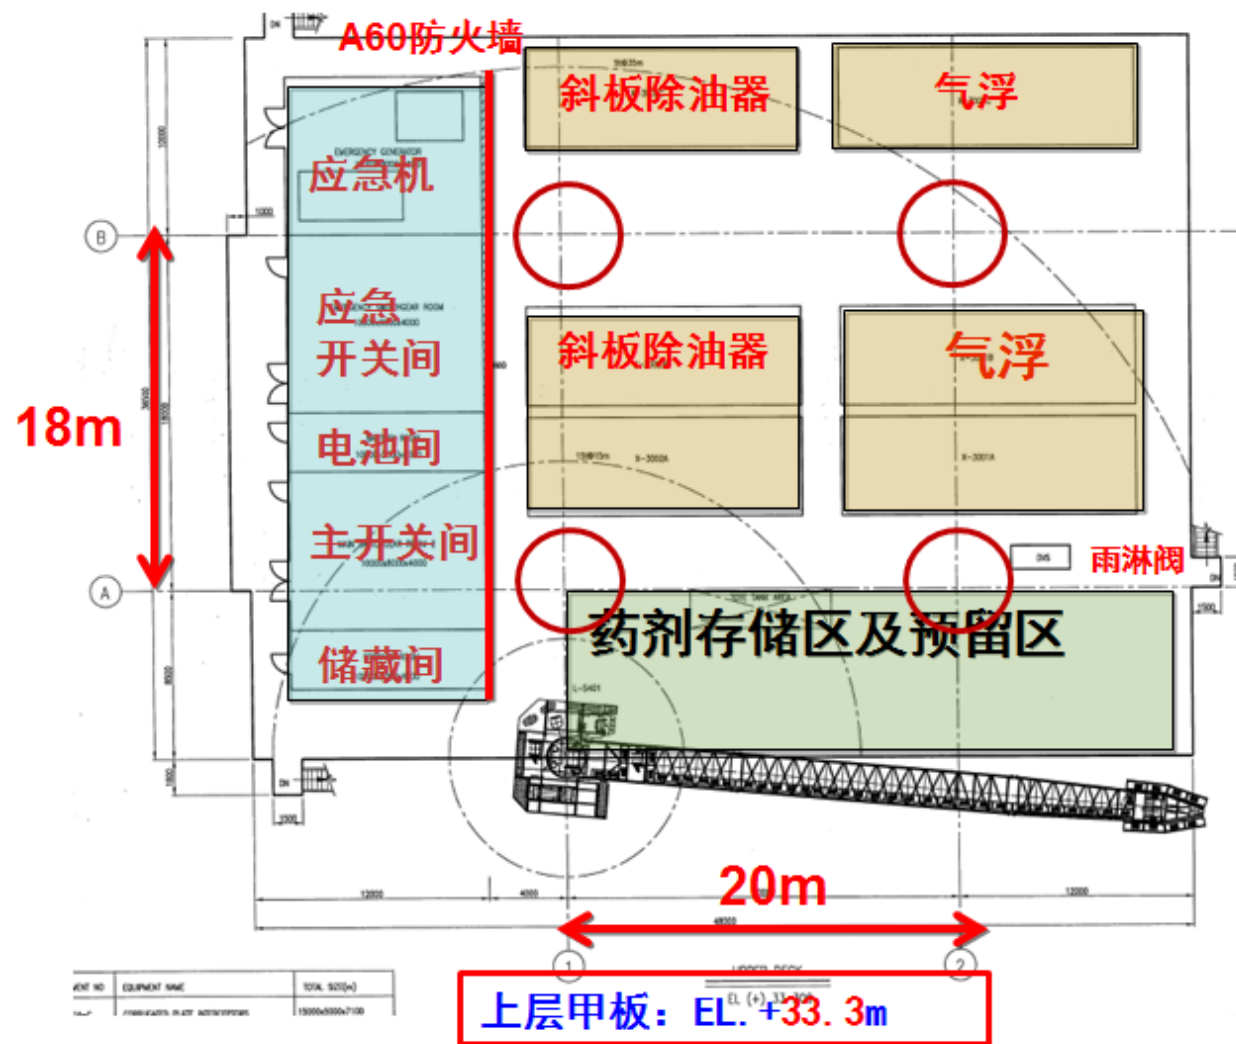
QHD32-6CEPK 上层甲板平面布置图
